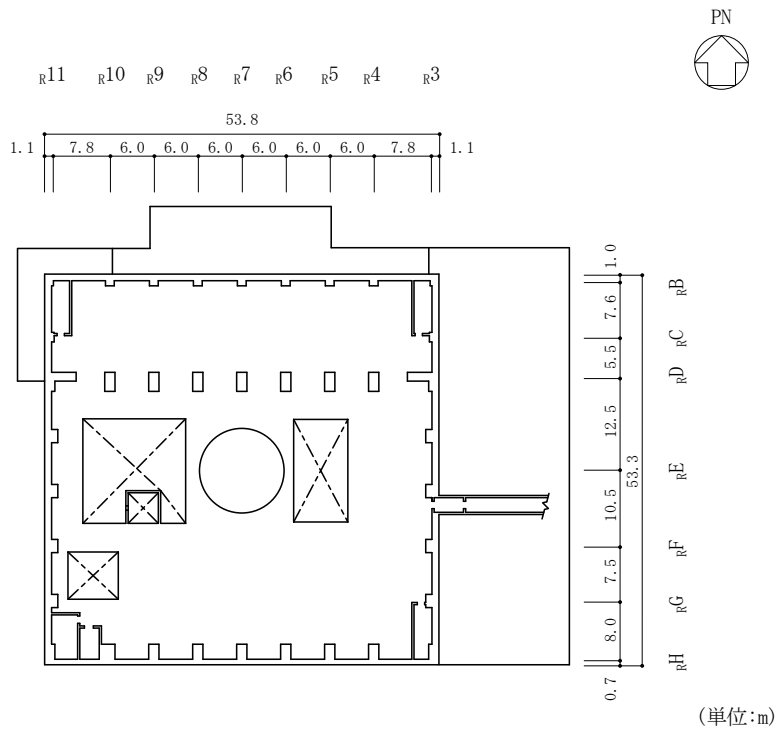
(7) 原子炉建物の概略平面図 (EL 42.8m)
